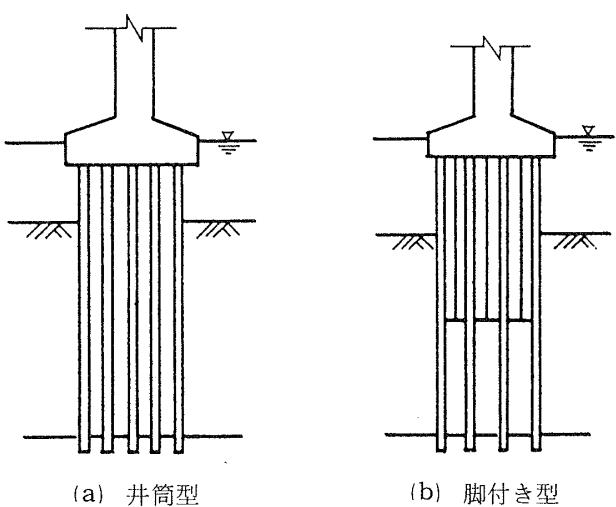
矢板式基礎の構造¹⁸⁵⁾
